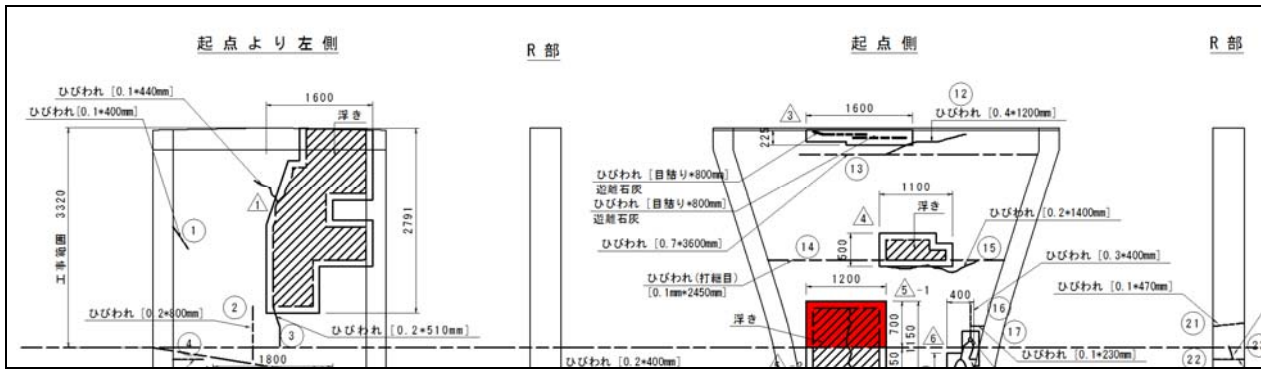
橋脚梁部のひび割れ・浮きに関する展開図 (P6 橋脚)
